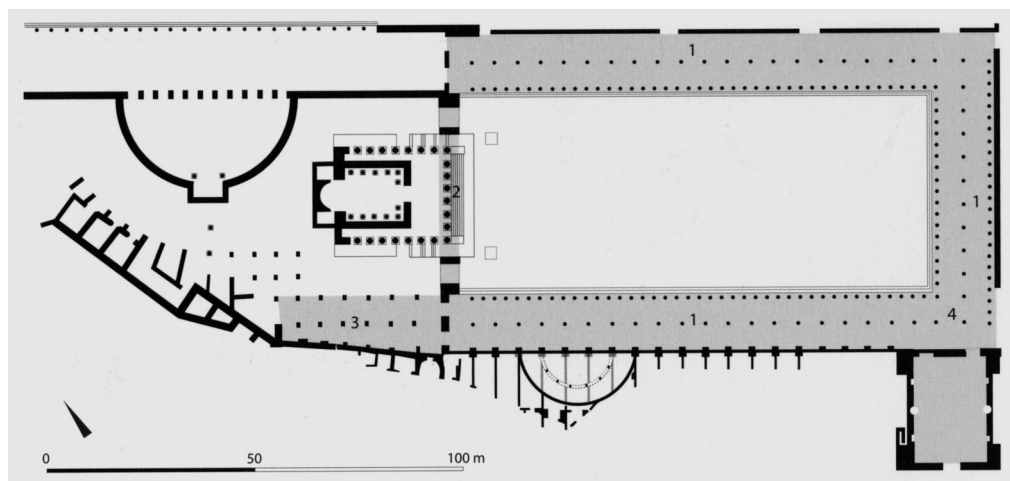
| Caesarforum: Grundriss mit Markierung der Bereiche spätantiker Baumaßnahmen (J. Lipps).
